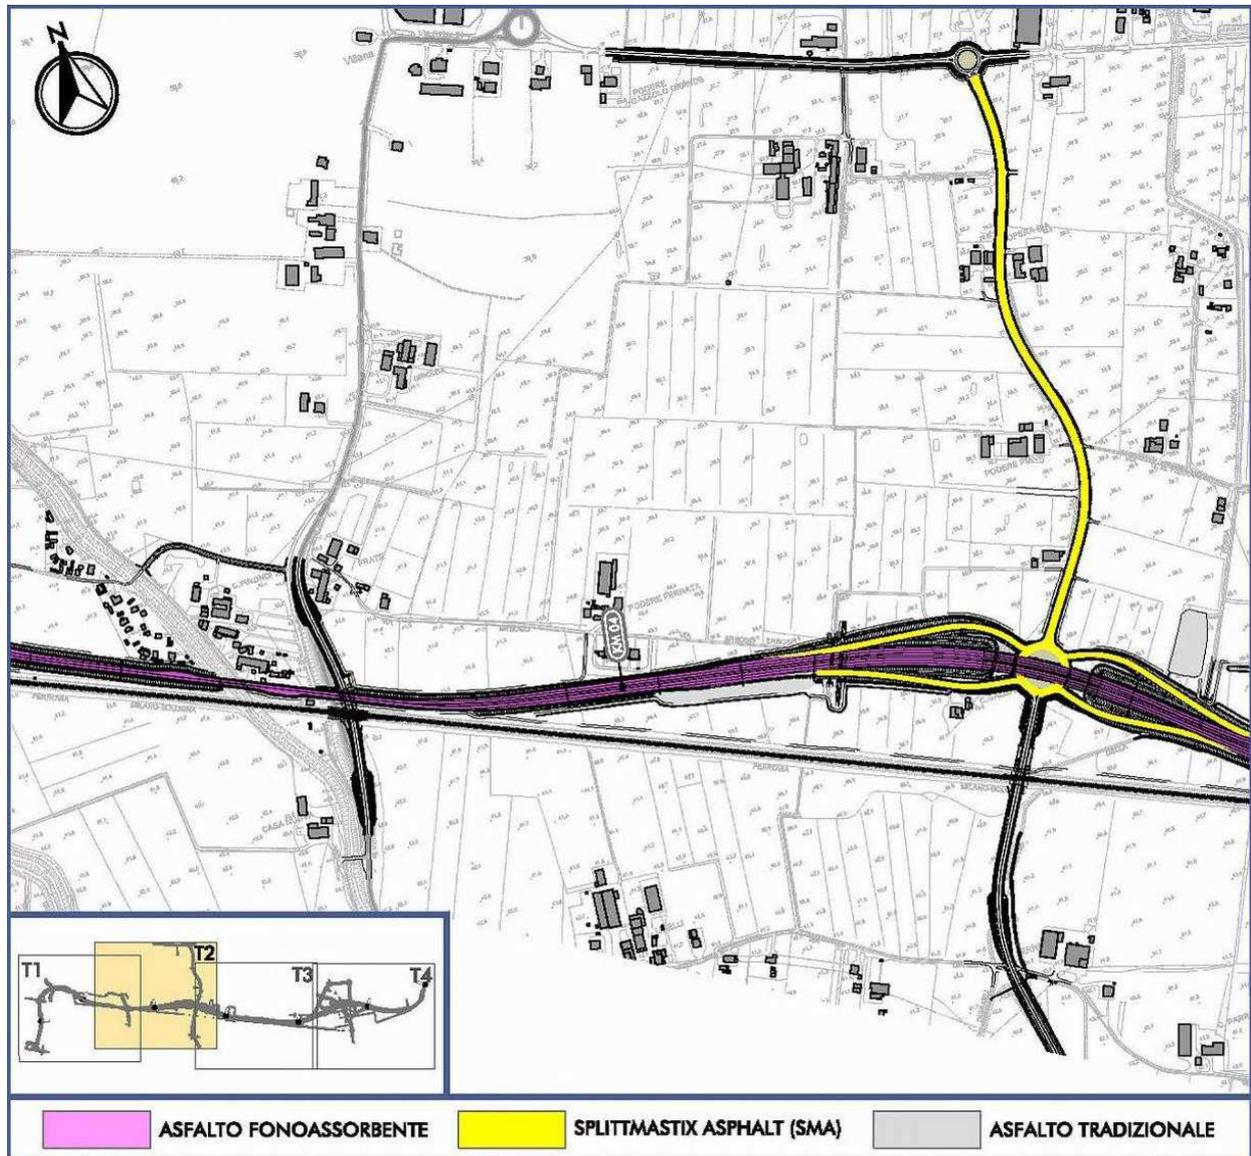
PAVIMENTAZIONI STRADALI DI PROGETTO NEL TRATTO TRA LE PK 3+400 E 4+500
